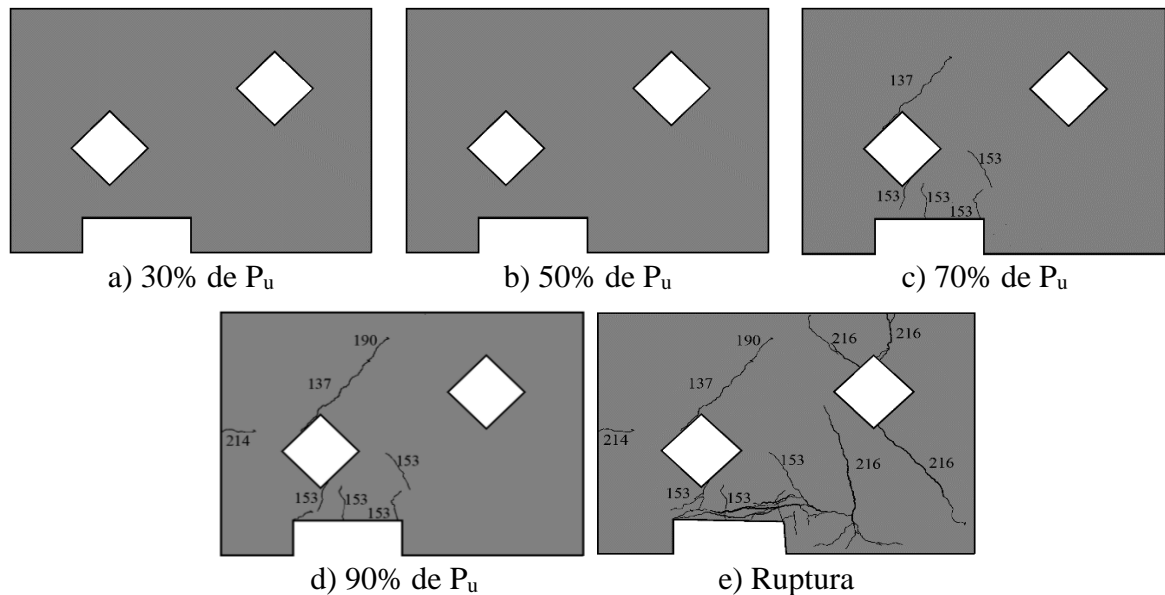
Mapa de fissuração DB3-H2-U-1 (força indicada em kN)
